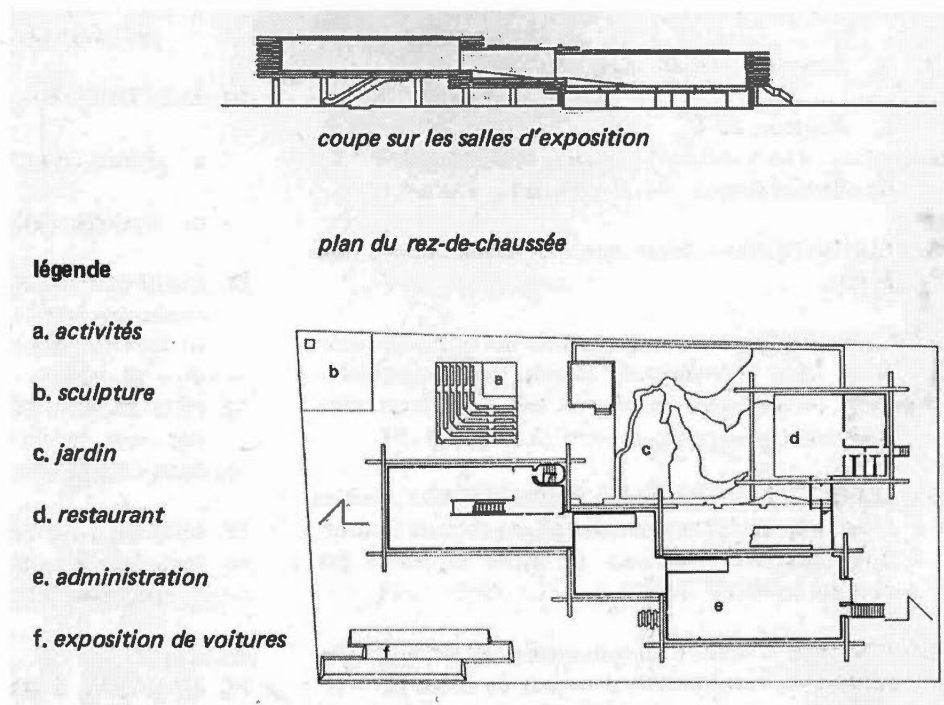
Coupe longitudinale et plan de site du pavillon du Japon
